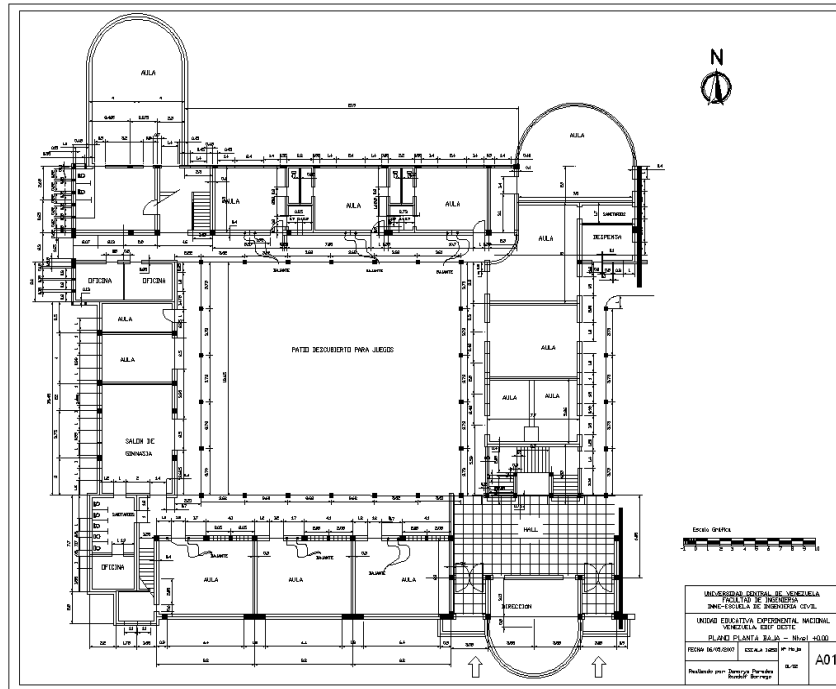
Plano digital de arquitectura de la planta baja del edificio oeste
